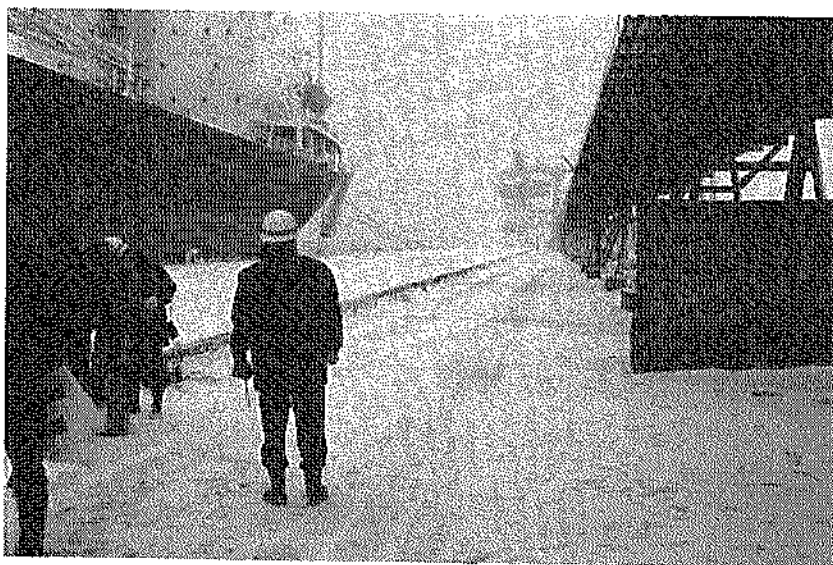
エブロン被災状況 (第2埠頭地区, ④・⑤南側岸壁(-12.0m))
